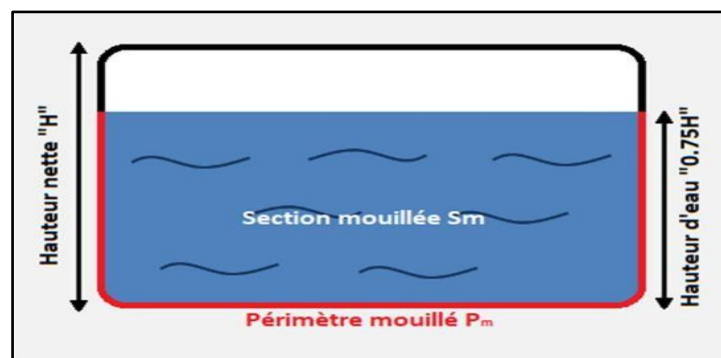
Schéma d'un ouvrage busé. [11]
